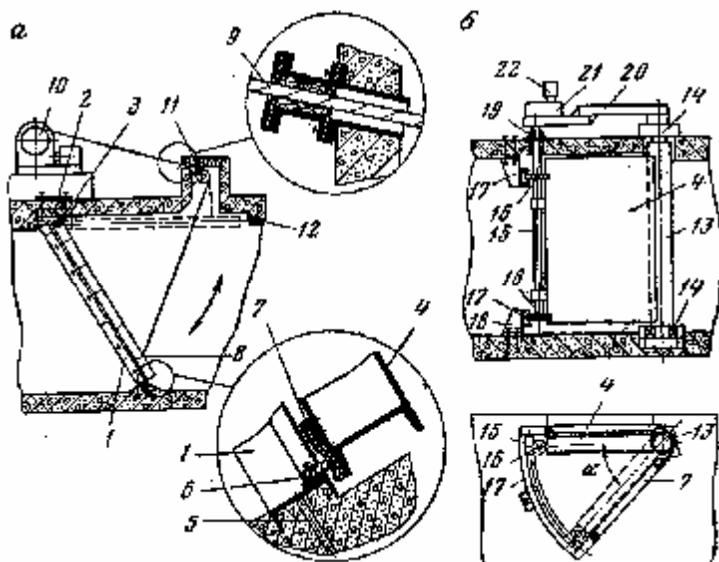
Конструкции ляд: а – лядя падающая, б – лядя самоходная; 1 – рама; 2 – подвесное устройство; 3 – шарнир; 4 – полотно ляды; 5 – крепежный элемент; 6 – полоса резины; 7 – полая резиновая прокладка; 8 – крепежный рым; 9 – канат; 10 – лебедка; 11 – блок; 12 – конечный отключатель; 13 – ось ляды; 14 – подшипник; 15 – приводной вал; 16 – шестерня привода; 17 – сектор; 18 – кронштейн крепления; 19 – изолирующая прокладка; 20 – рама привода; 21 – редуктор; 22 – двигатель
